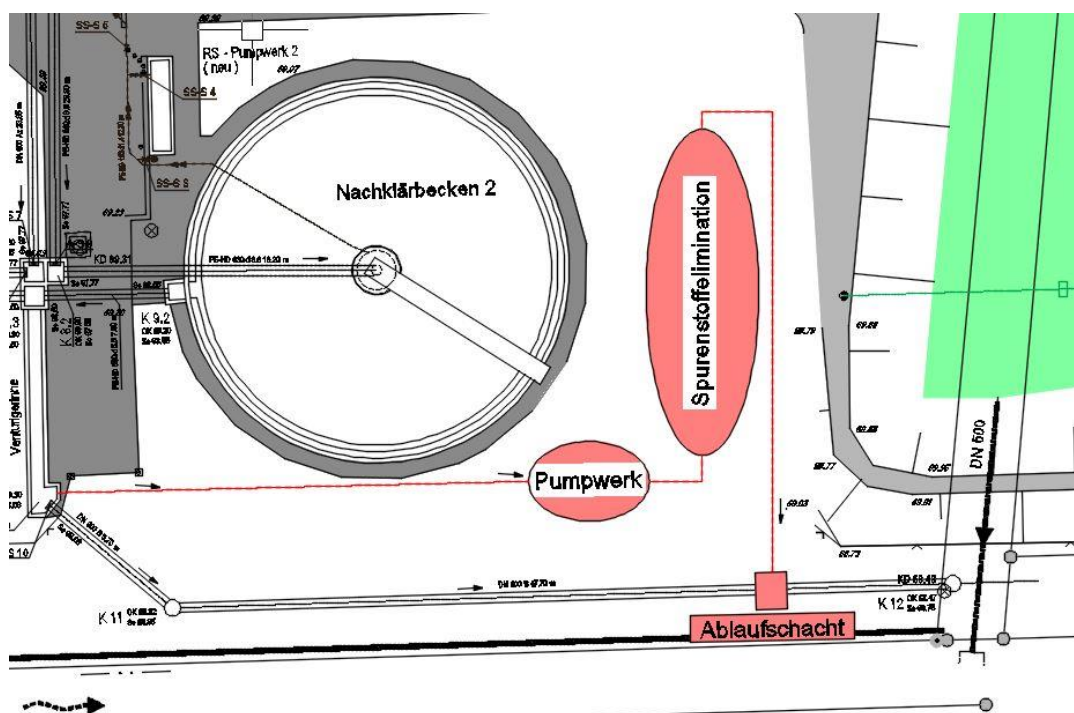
Darstellung der zu bebauenden Fläche im Lageplan
